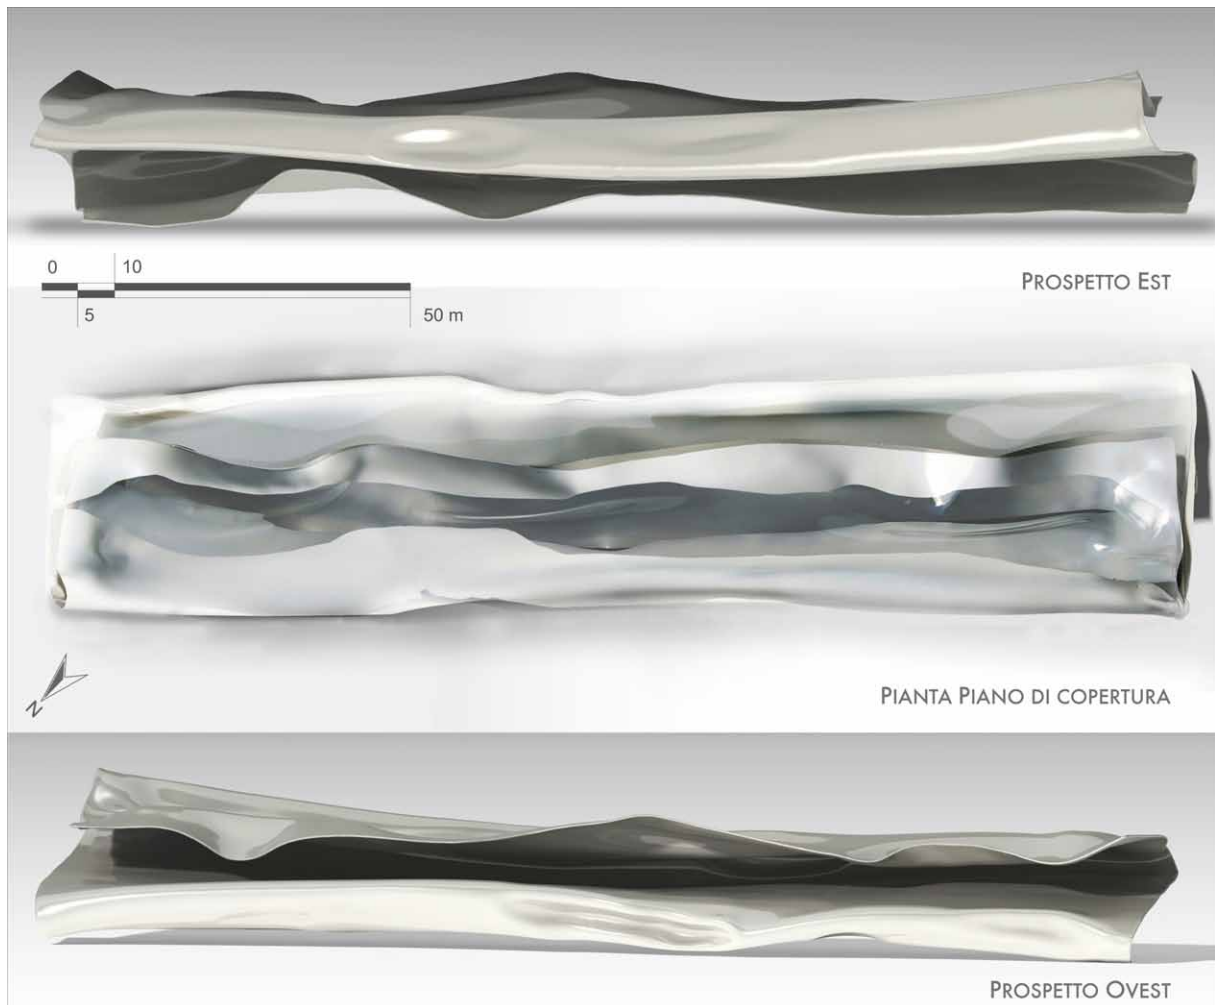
Pianta del piano di copertura e prospetti longitudinali
